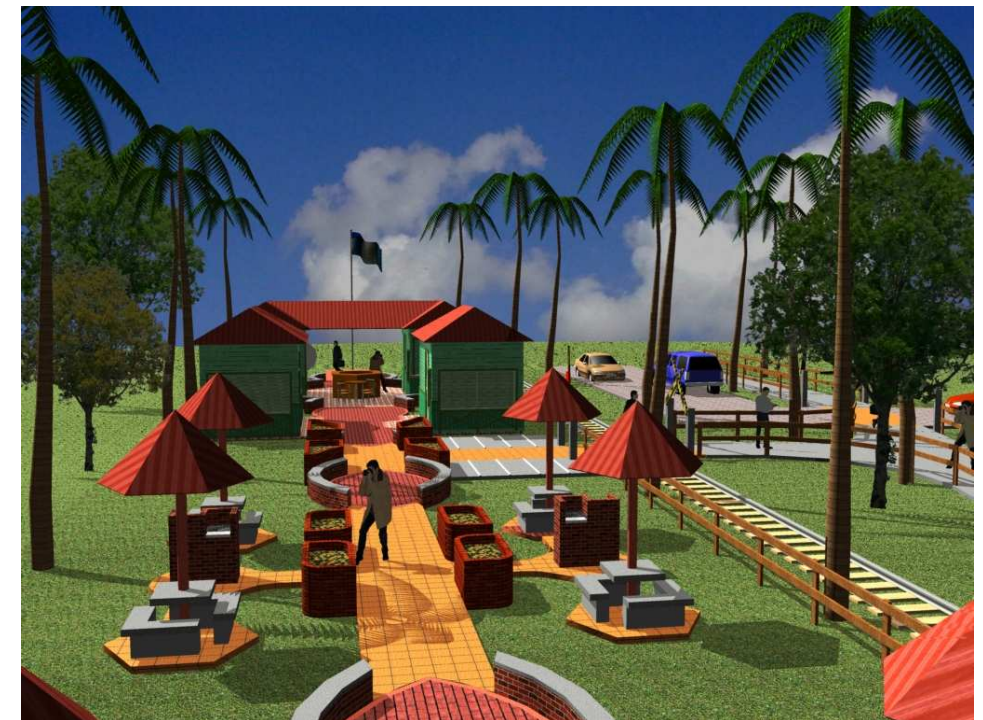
Vista de Norte a Sur del Conjunto de Cristina
